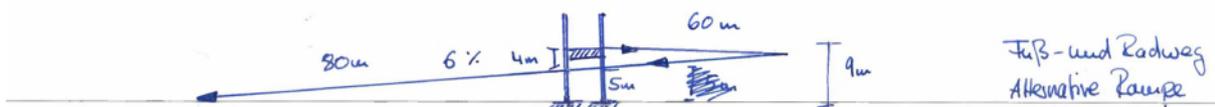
Skizze (Lageplan und Schnitt) der alternativen Rampenanbindung auf dem Grundstück 348/86
